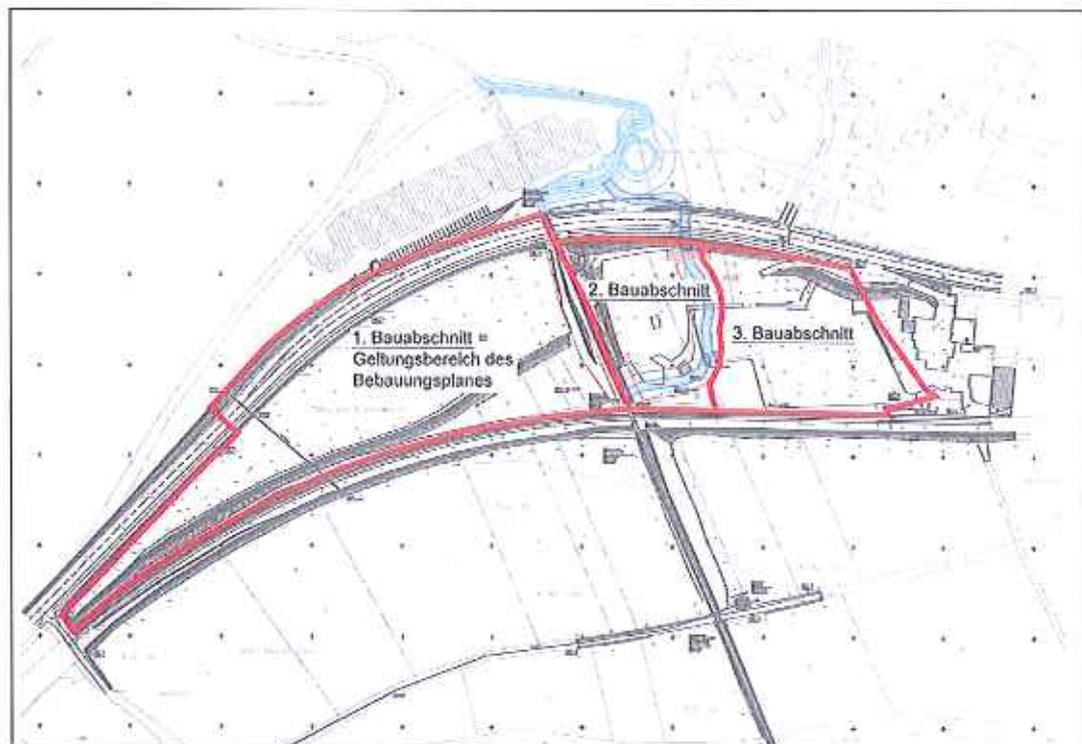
Geplante Bauabschnitte (ohne Maßstab)
